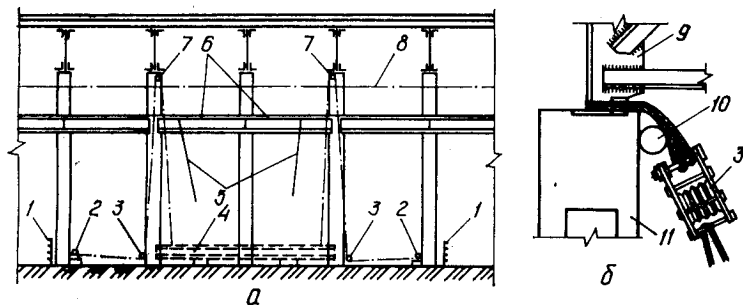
Демонтаж подкрановых балок лебедками:
